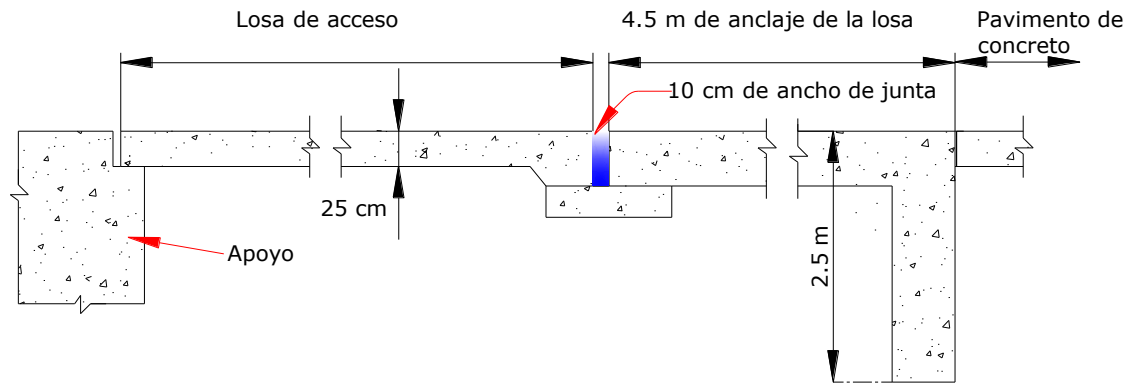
Losa de acceso y continuación con un anclaje de concreto de 4.5 m
